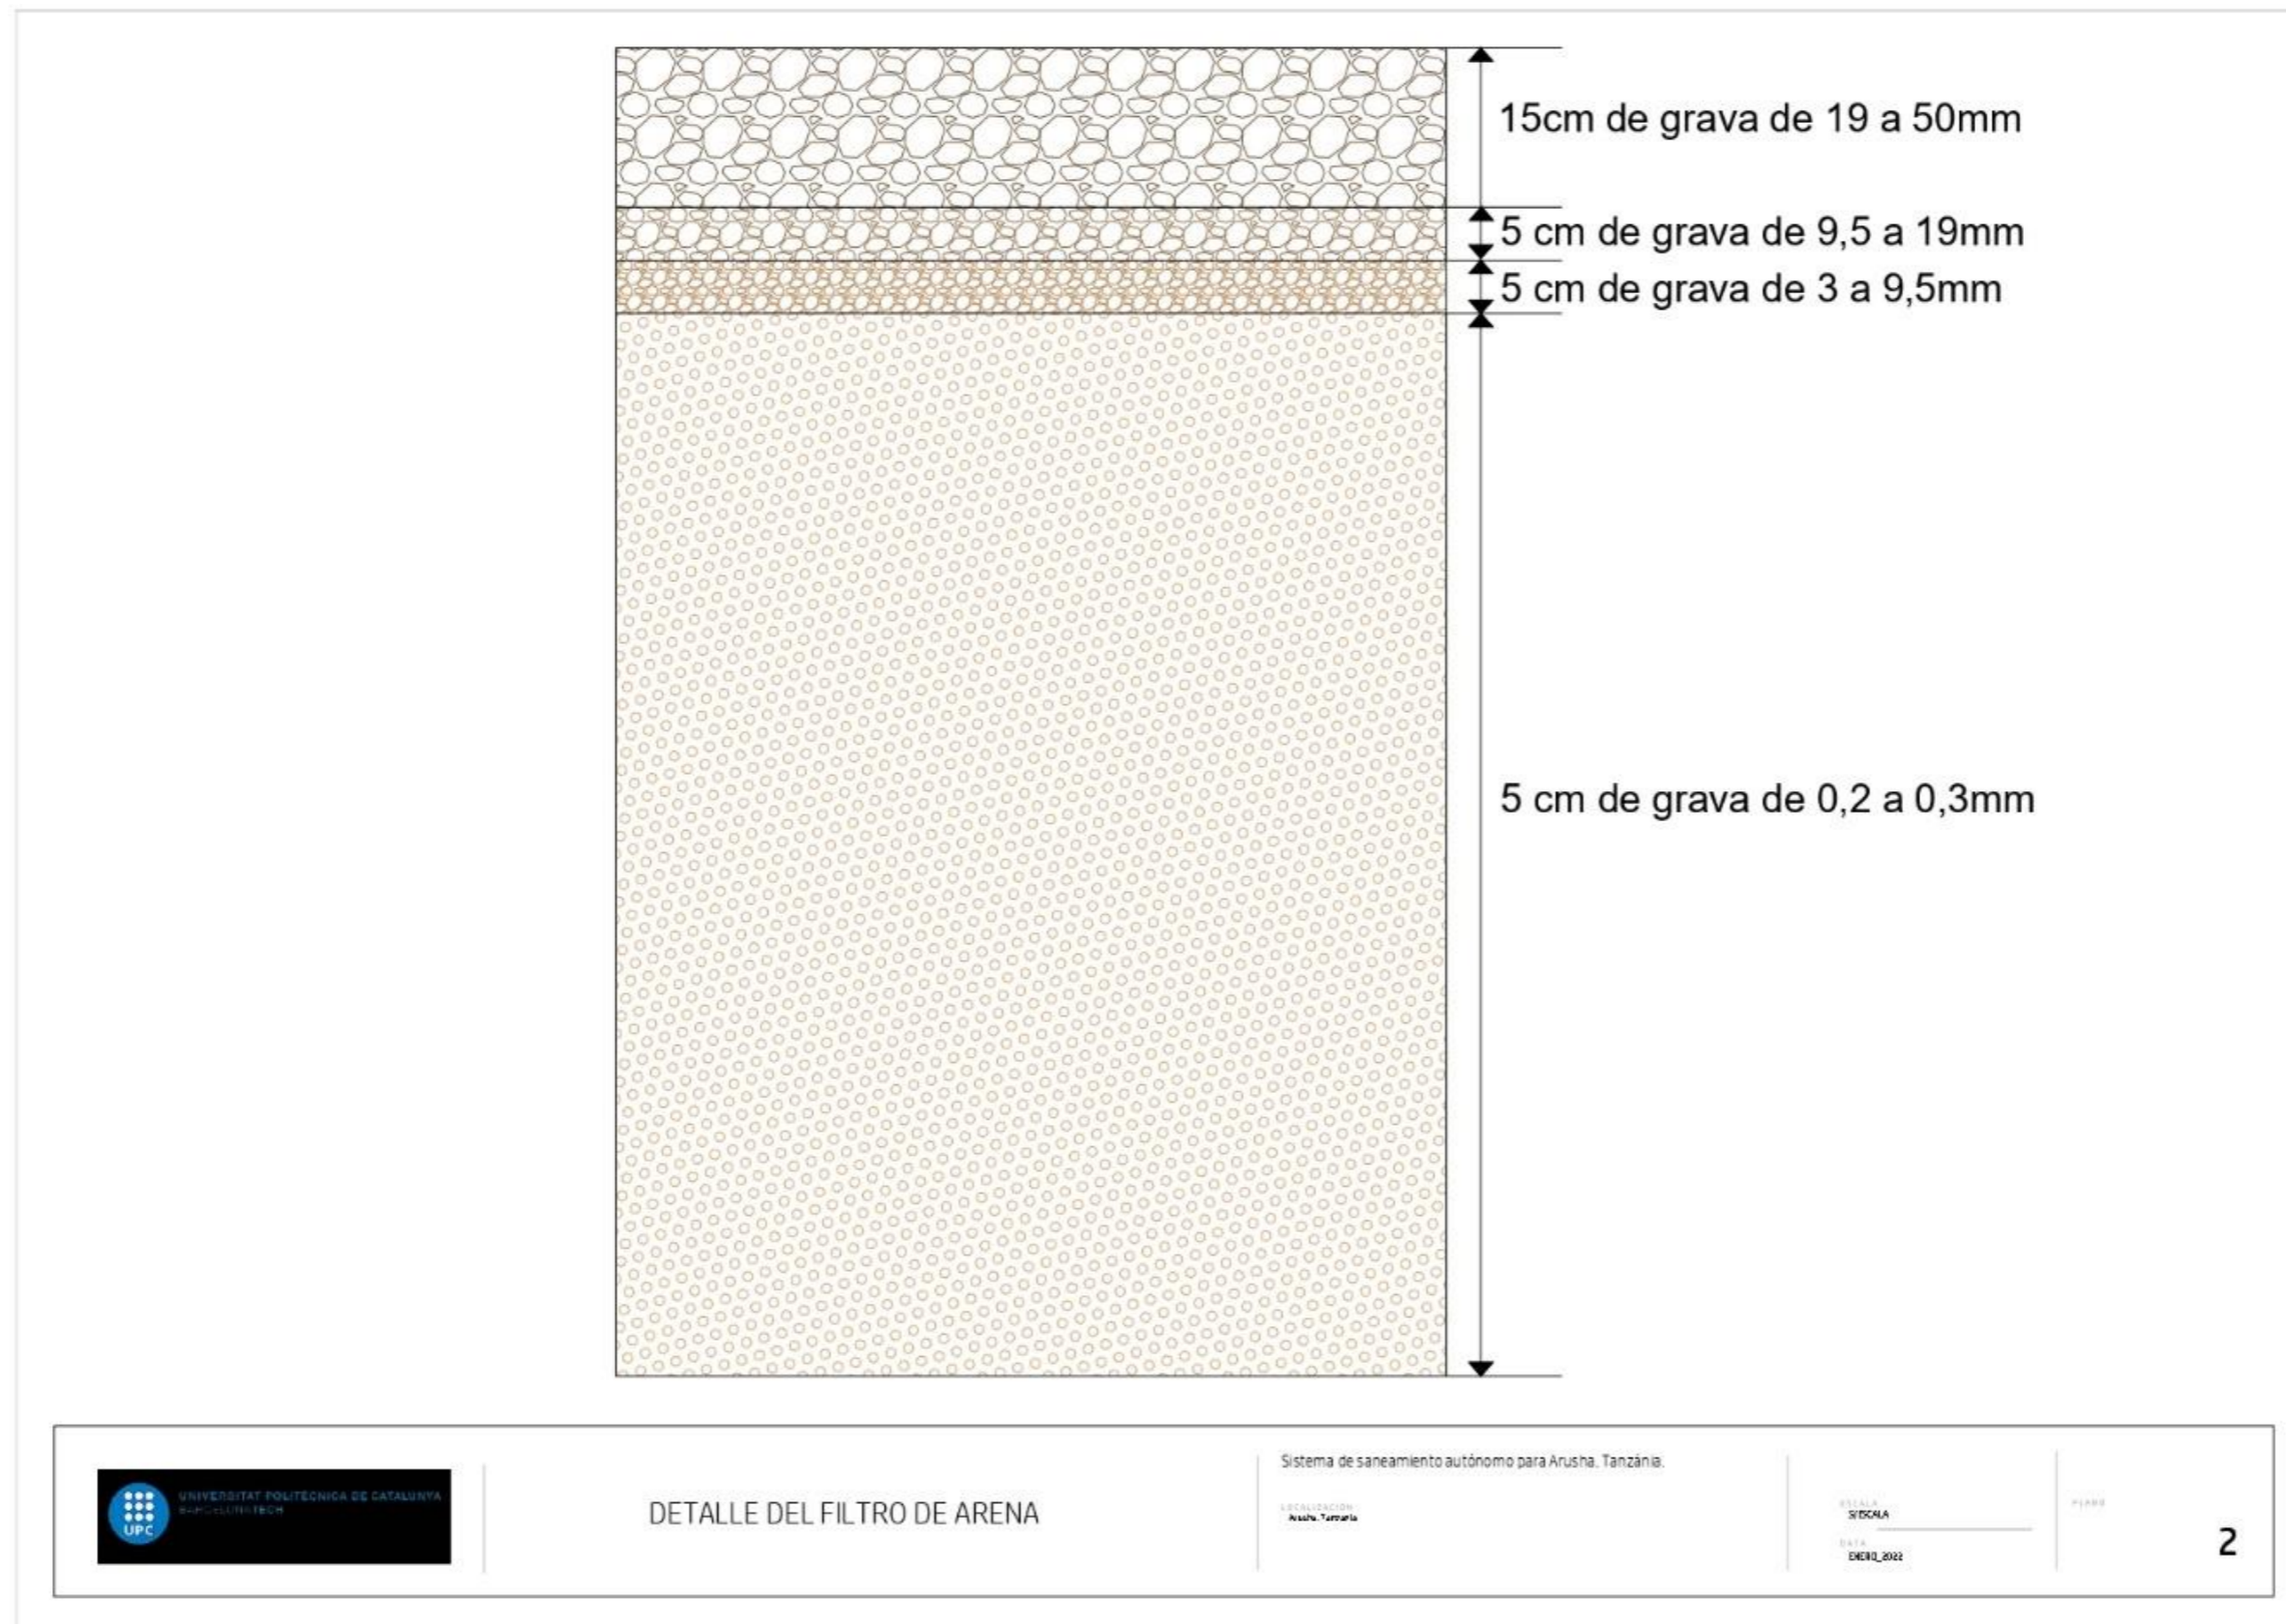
Plano de detalle de las capas del filtro de arena. Vía: elaboración propia.
